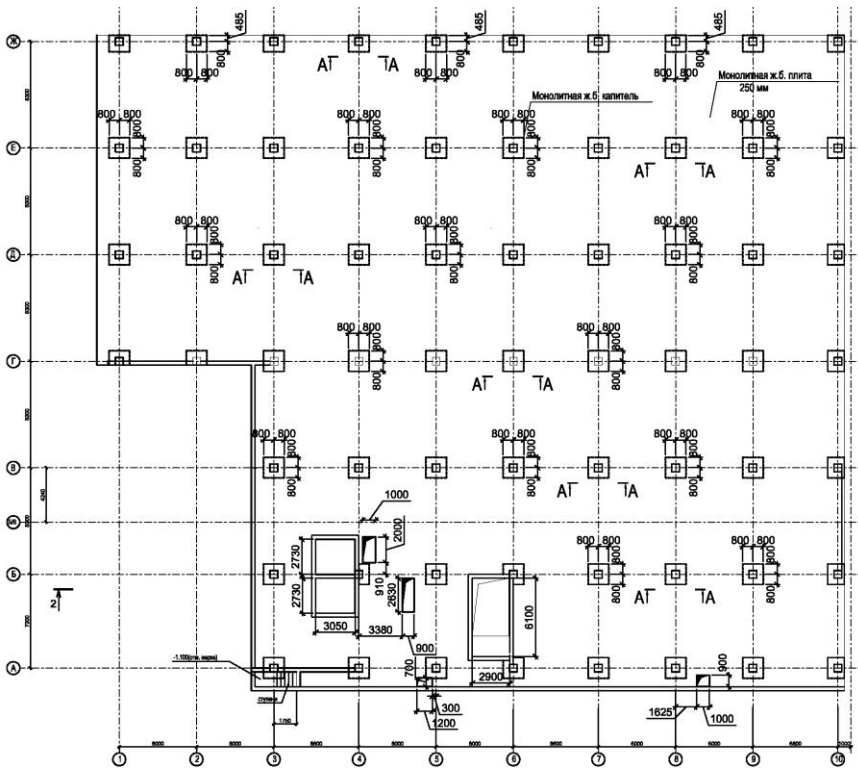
Пример компоновки безбалочного перекрытия с капитальным стыком колонны и плиты перекрытия— план (фрагмент)
